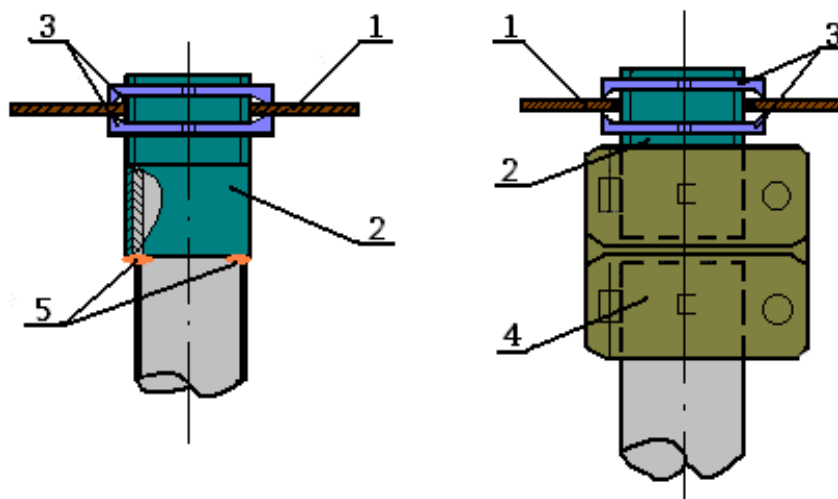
Ввод труб без резьбы в аппараты и коробки:
